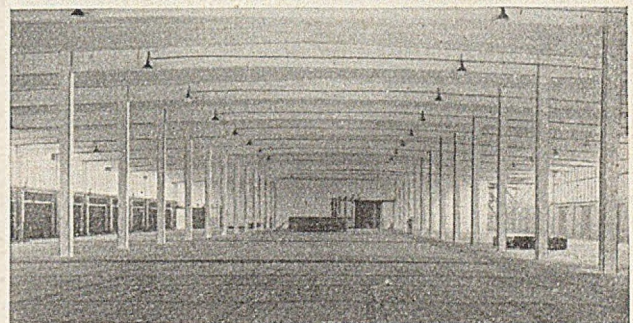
Schuppen 55, Spannbetonbauweise (vgl. Übersicht).
